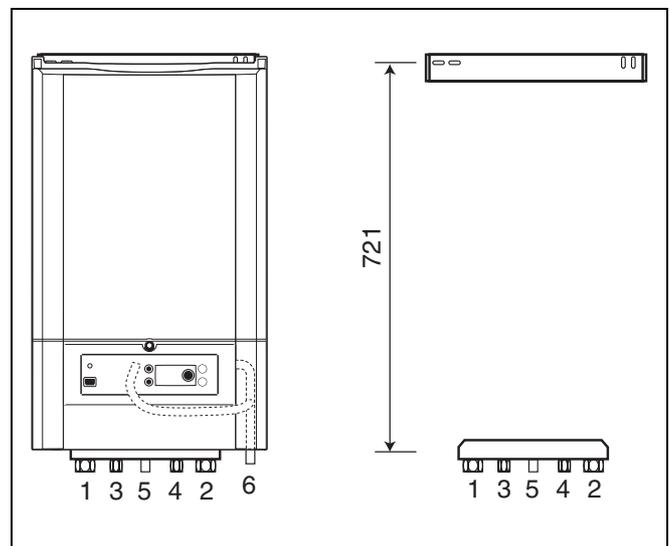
Piastra di collegamento per il montaggio e collegamenti
